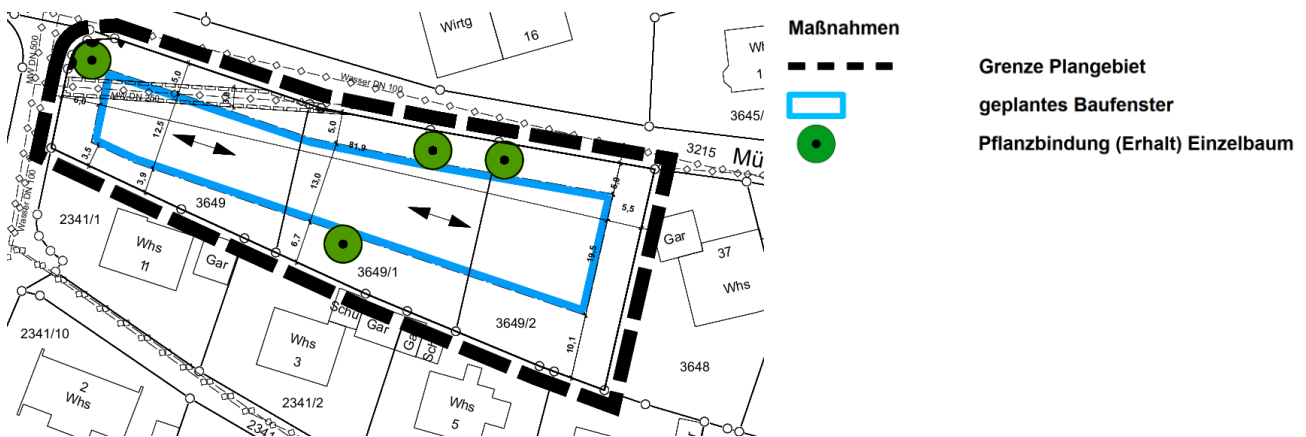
Maßnahmenplan (Quelle: galaplan decker, Stand: 23.03.2026)
